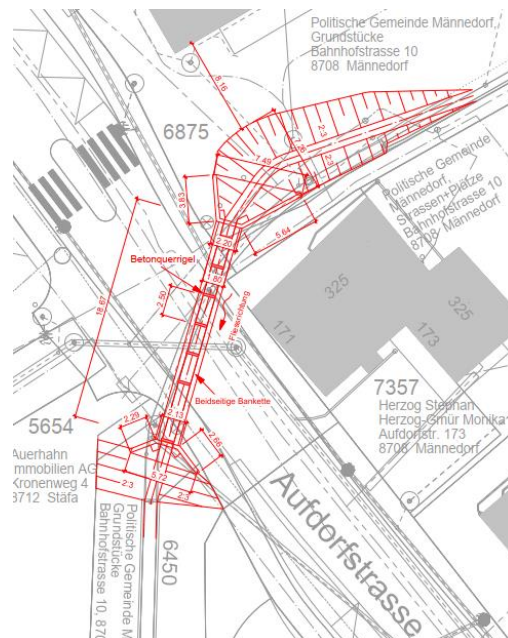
Situationsplan des Bauprojekts «Sanierung Aufdorf-/Gseckstrasse Eindolung Chlingenbach» (marti+dietschweiler AG 2019)
